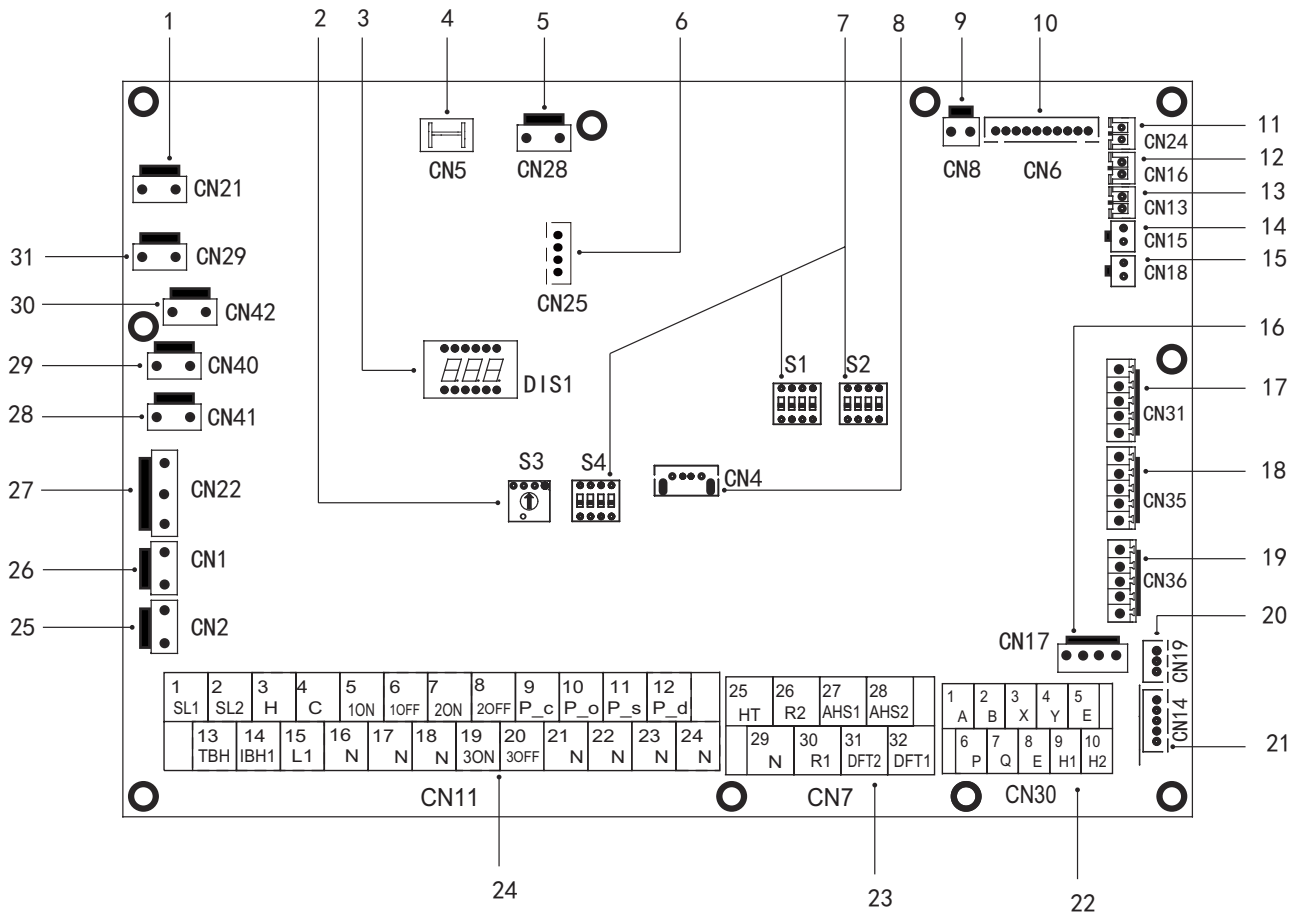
Detalle de la tarjeta hidráulica de la bomba de calor
